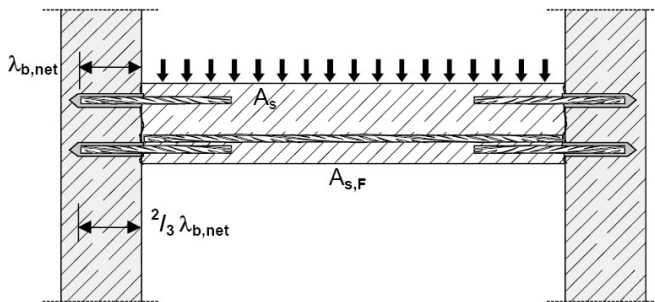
Ancrage direct d'armatures pour élément principalement en compression. Les armatures subissent une contrainte en compression.
